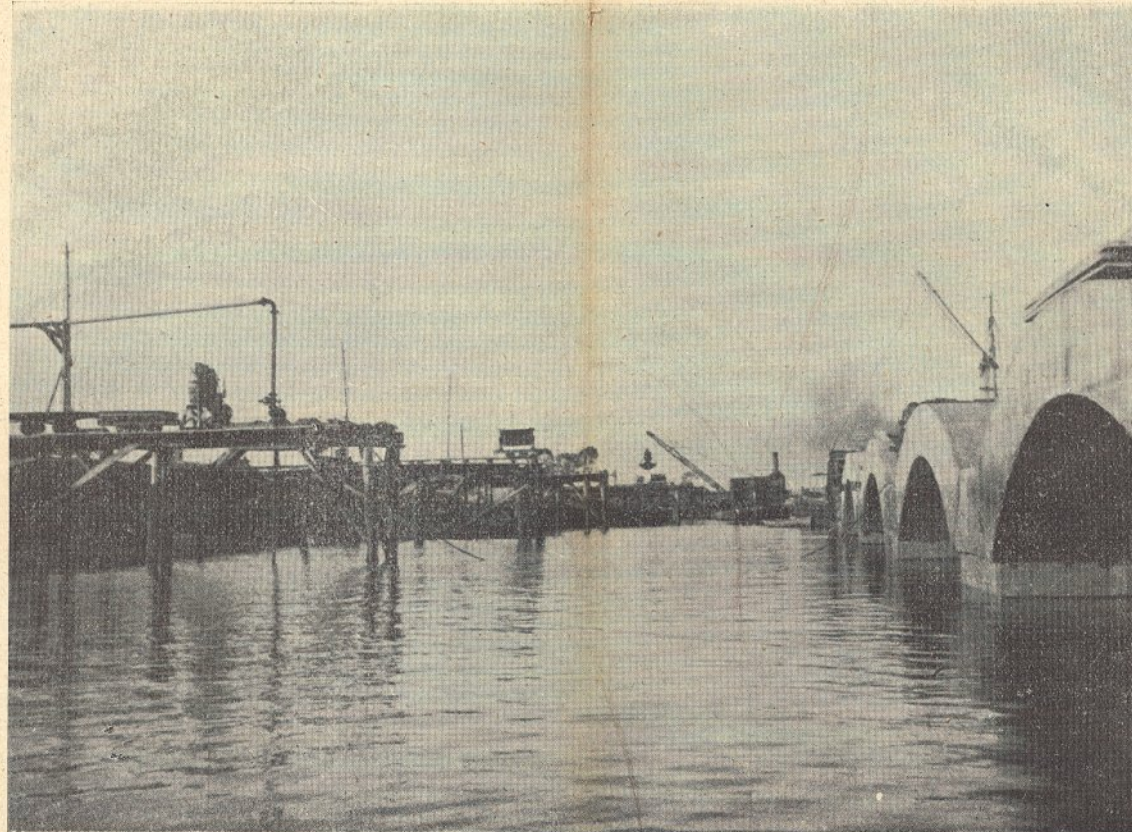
Vista das abobadas do muro do cais, do lado do aterro
